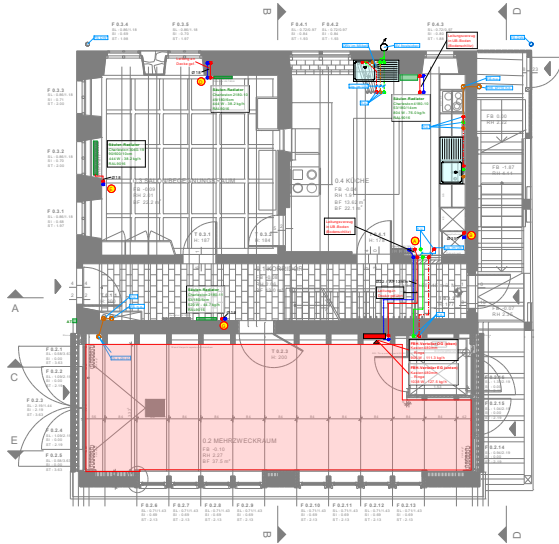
Grundriss EG Koordinationspläne
